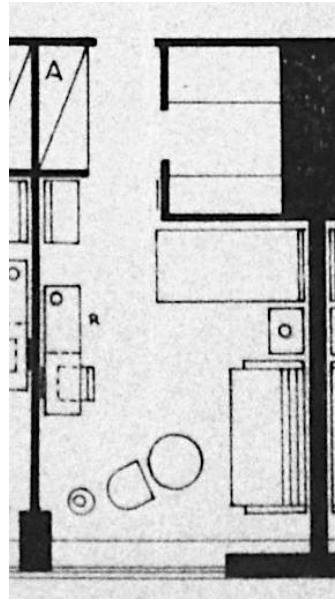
Grundriss Zimmertyp „Studio“
